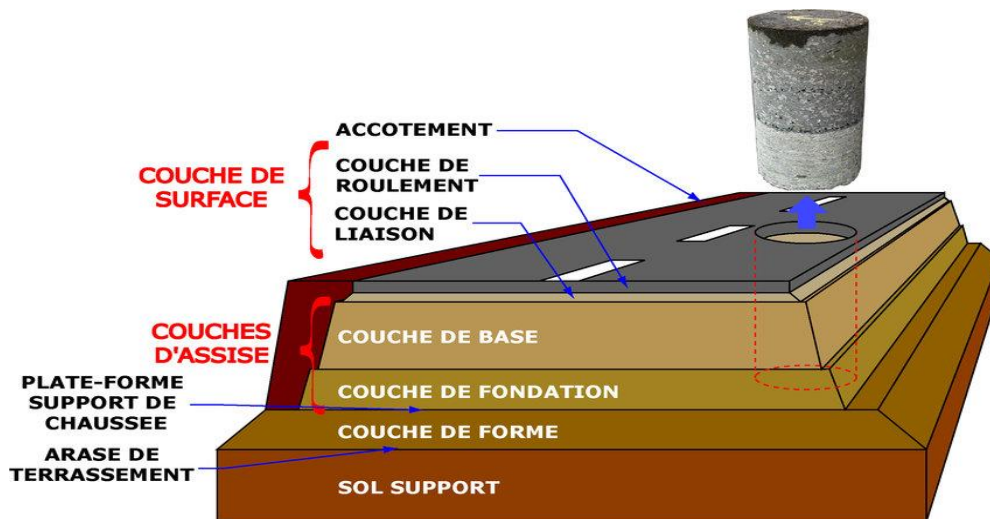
Différentes Couches Constituant La Structure De La Chaussée
